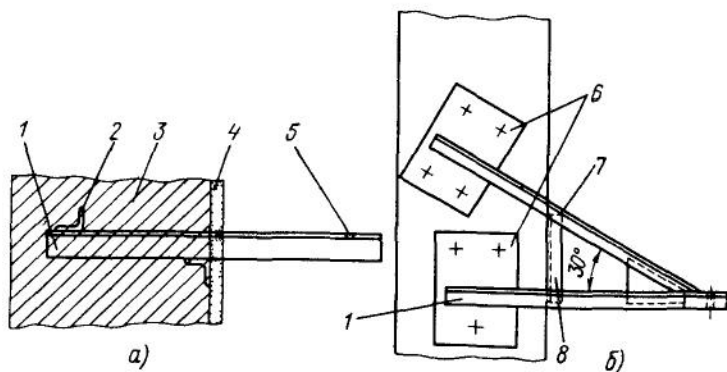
Крепление горизонтальных воздухопроводов с помощью кронштейнов: а – к кирпичной стене, б – к железобетонной колонне; 1 – кронштейн, 2 – уголок-подкладка, 3 – стена, 4 – штукатурка, 5 – отверстие для подвески, 6 – накладки, 7 – подкос, 8 – стойка (знаком "+" показаны места пристрелки)
